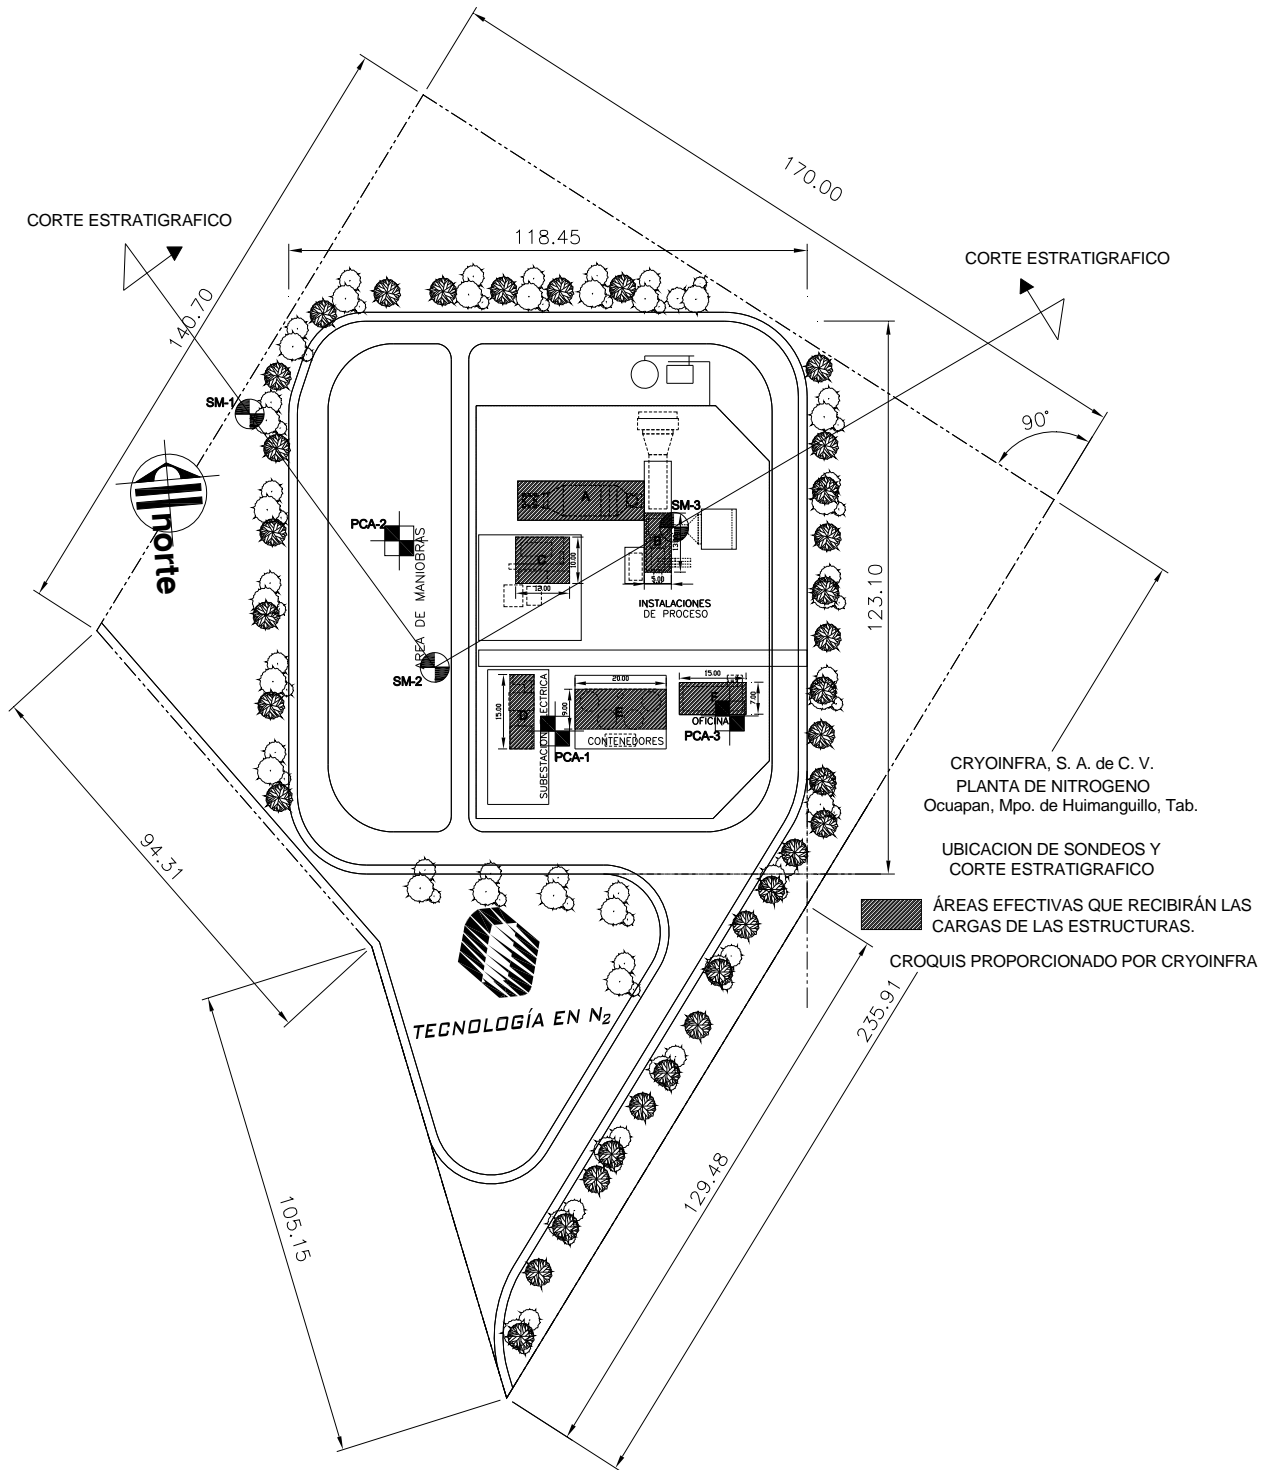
ANEXO. Distribución de las estructuras a cimentar.
